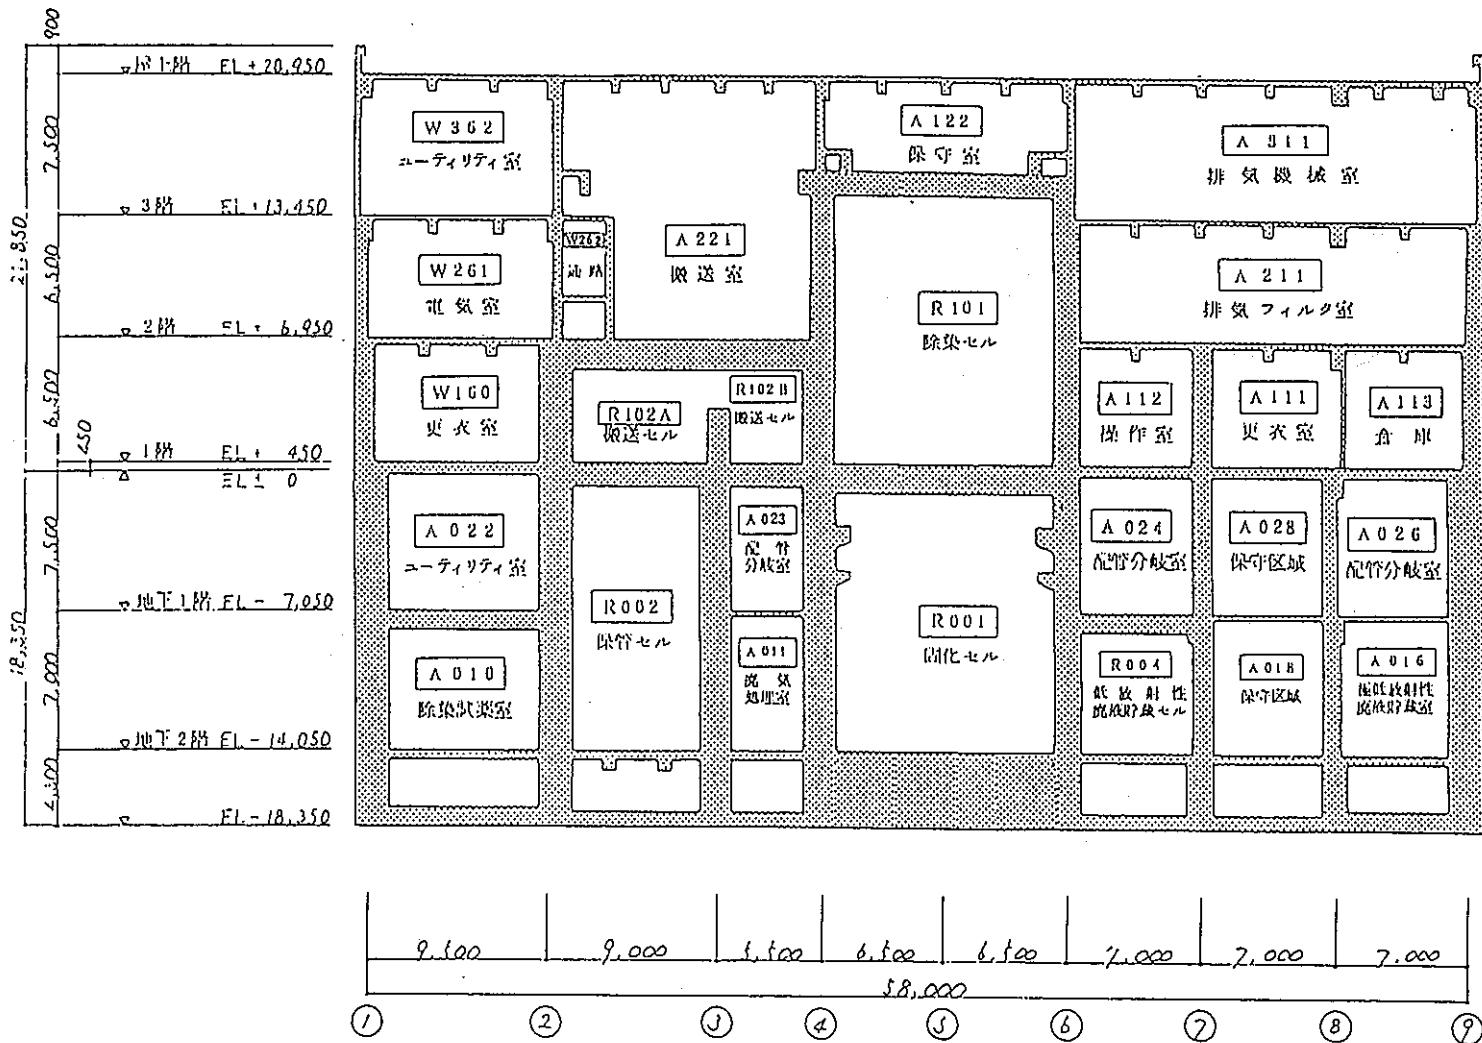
ガラス固化技術開発棟 断面図(2)
